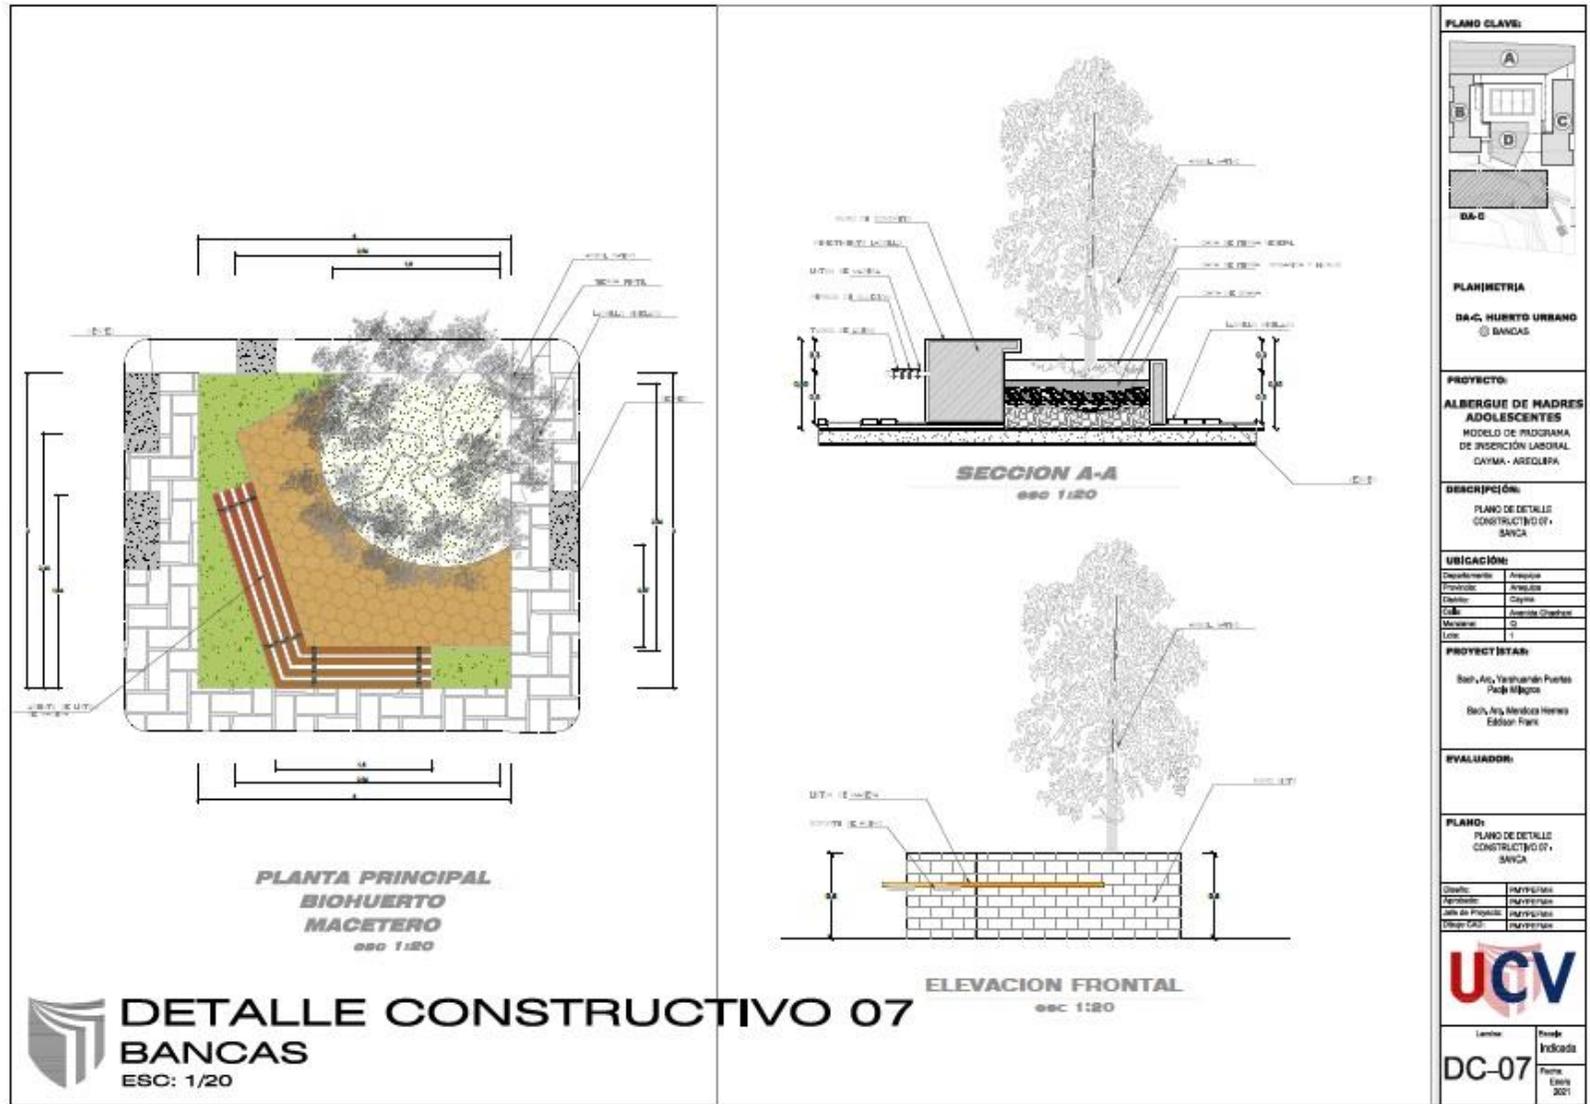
Detalle Constructivo 07 – Bancas en Zonas exteriores DC-07.
